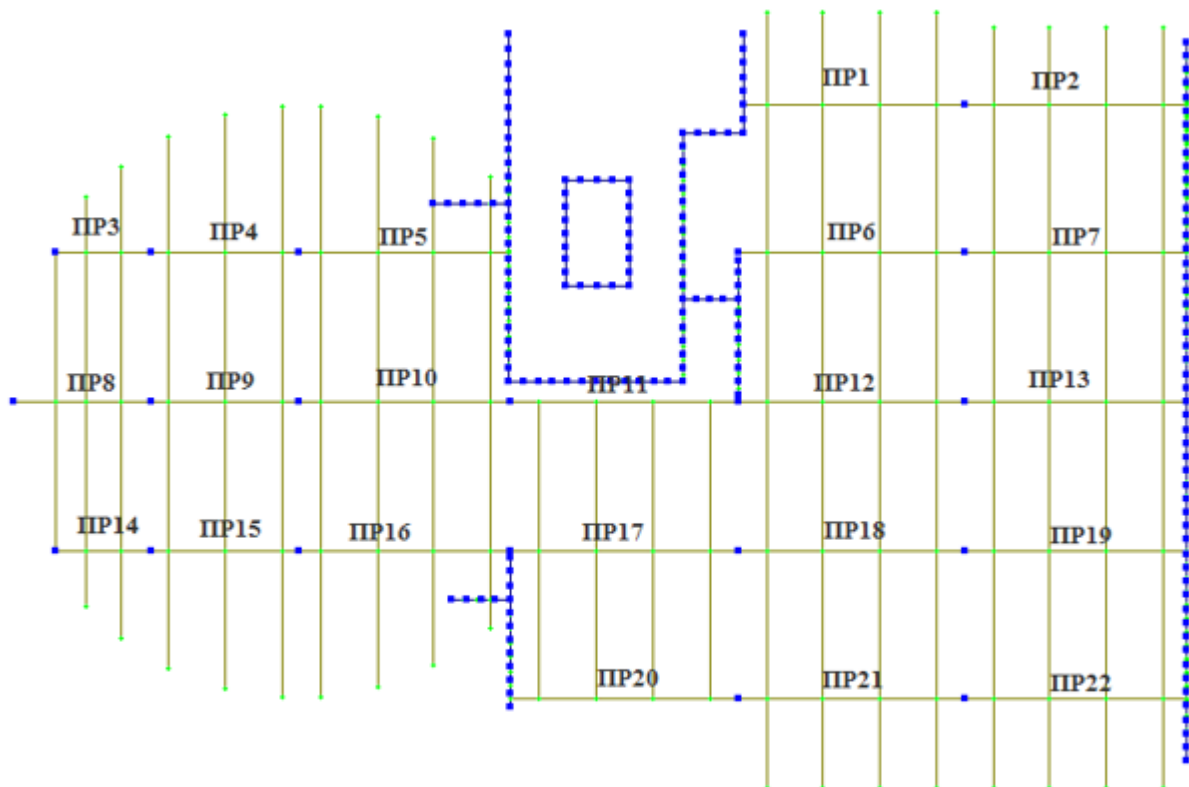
Схема розташування поздовжніх ребер перекриття (головних балок)
